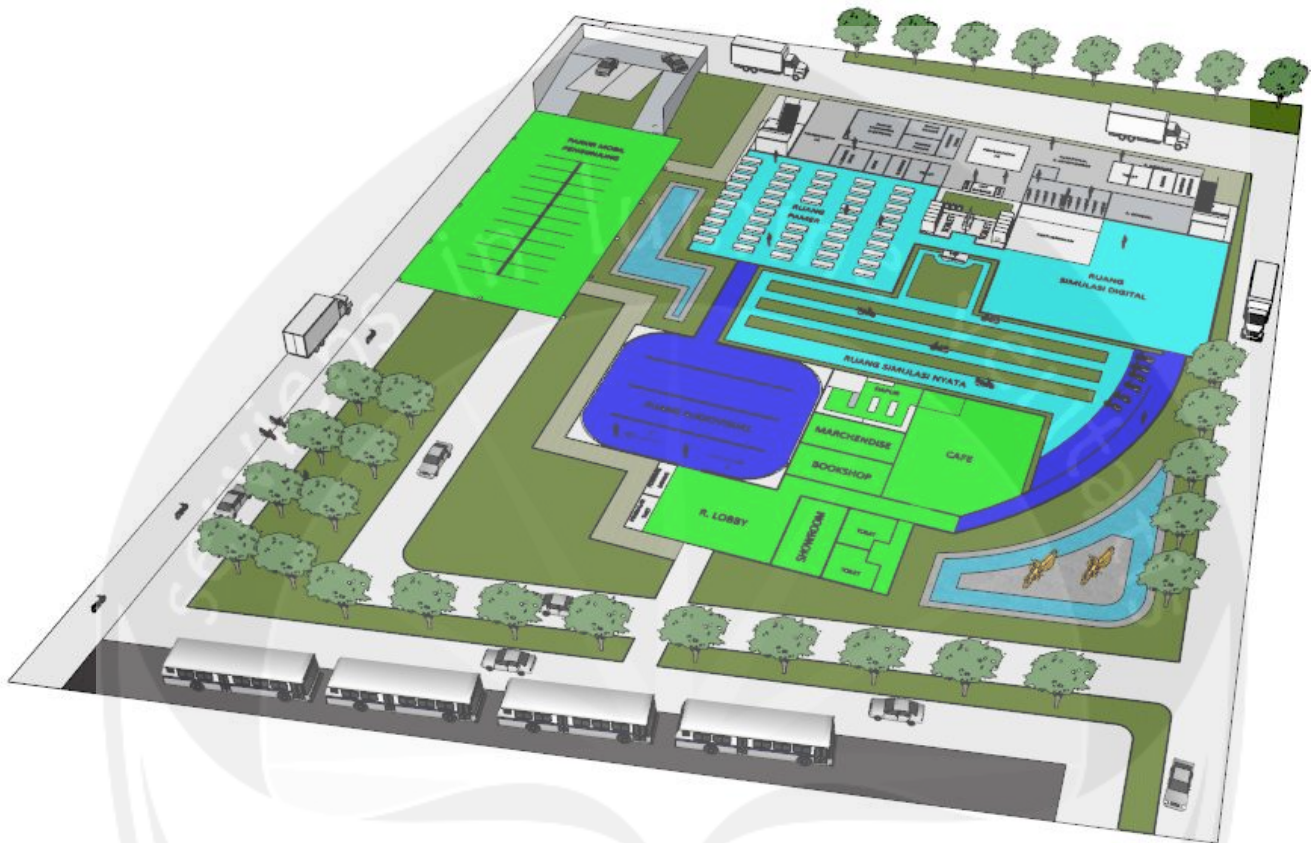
Konsep Ruang Horizontal Lantai 2
